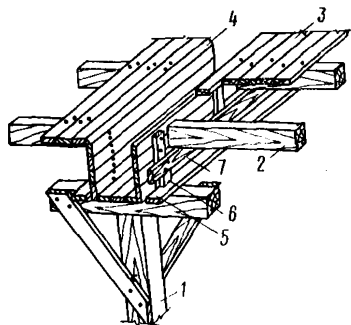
Неинвентарная деревянная опалубка железобетонной балки
